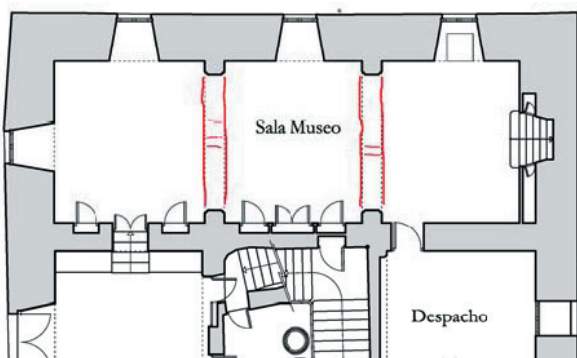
Representación en planta de las grietas en los dos arcos de sillería.
